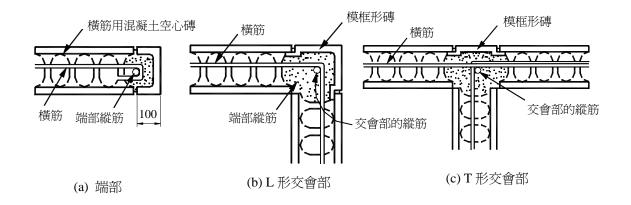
結構牆端部、L形、T形交會部模框形磚施工例
